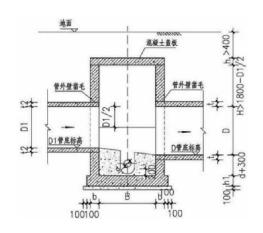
初期雨水弃流井 1-1 剖面图 (单位: mm)
